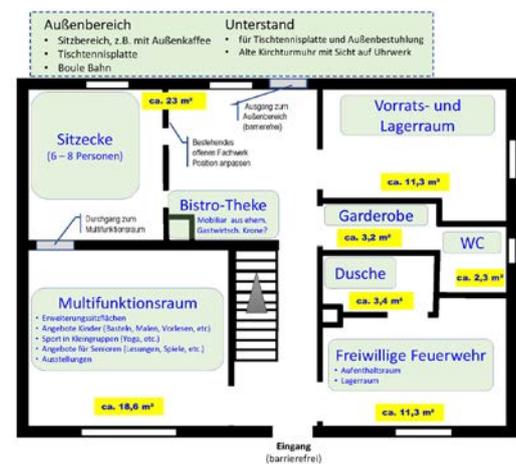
Idee zur Neuordnung des Erdgeschoss-Grundriss
